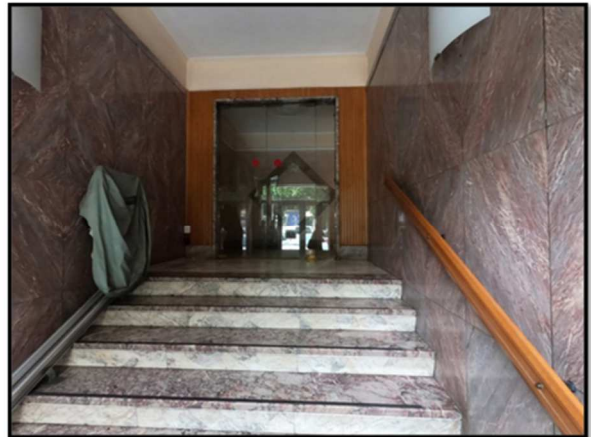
4 Prospetto interno cortile condominiale e ingresso condominiale
